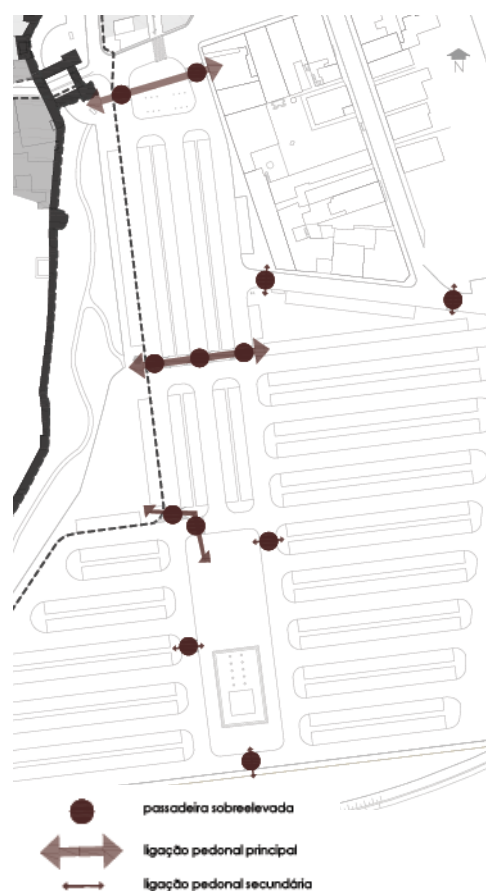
Ligações pedonais entre a Vila Adentro e o Largo de São Francisco e localização das passadeiras sobrelevadas.
